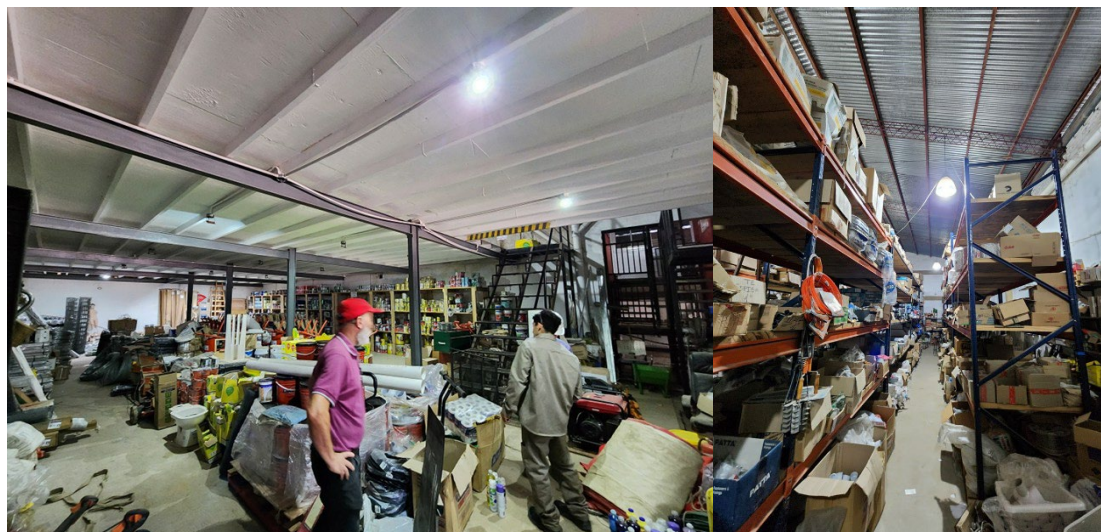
(Izquierda) Depósito en planta baja. (Derecha) Depósito en planta alta.
